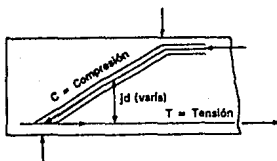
Acción de arco de una viga (Ref. 3)
